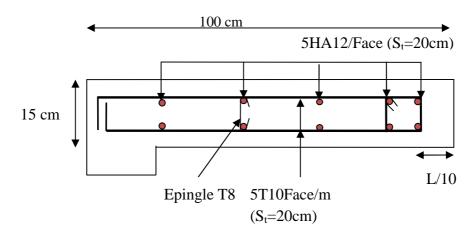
Schéma de ferraillage du voile Vx1 des niveaux 2et 3
